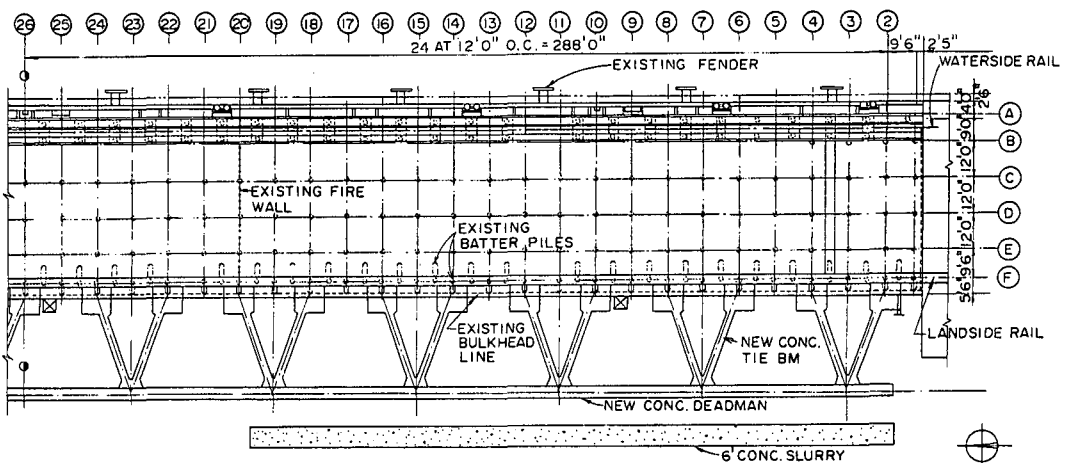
ロサンジェルス港 B126 (Old) 岸壁の平面図
